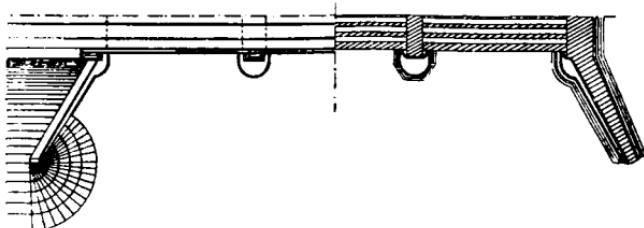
Планъ устоя съ откосными крыльями у того же моста.
